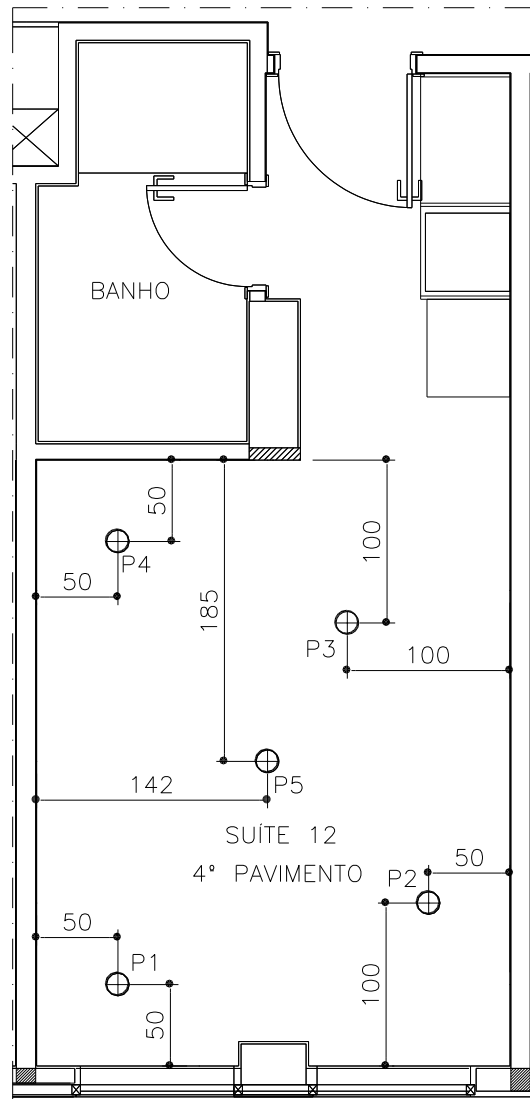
Planta do ambiente de ensaio contendo posições de microfone (Suíte do Ambiente Receptor - pavimento inferior).
